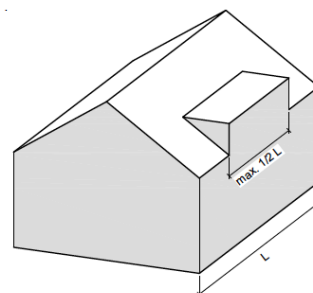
schematische Darstellung Dachaufbauten gemäss neuPBG (1/2 der Fassadenlänge)
